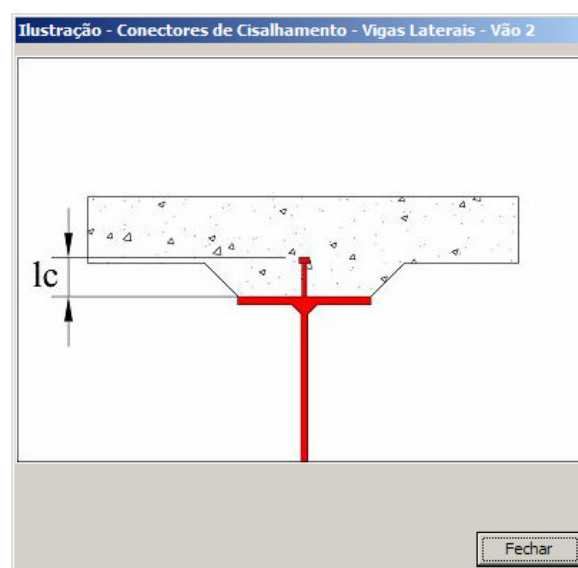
Ilustração do comprimento dos conectores e número de filas para o vão central das vigas mistas laterais.
